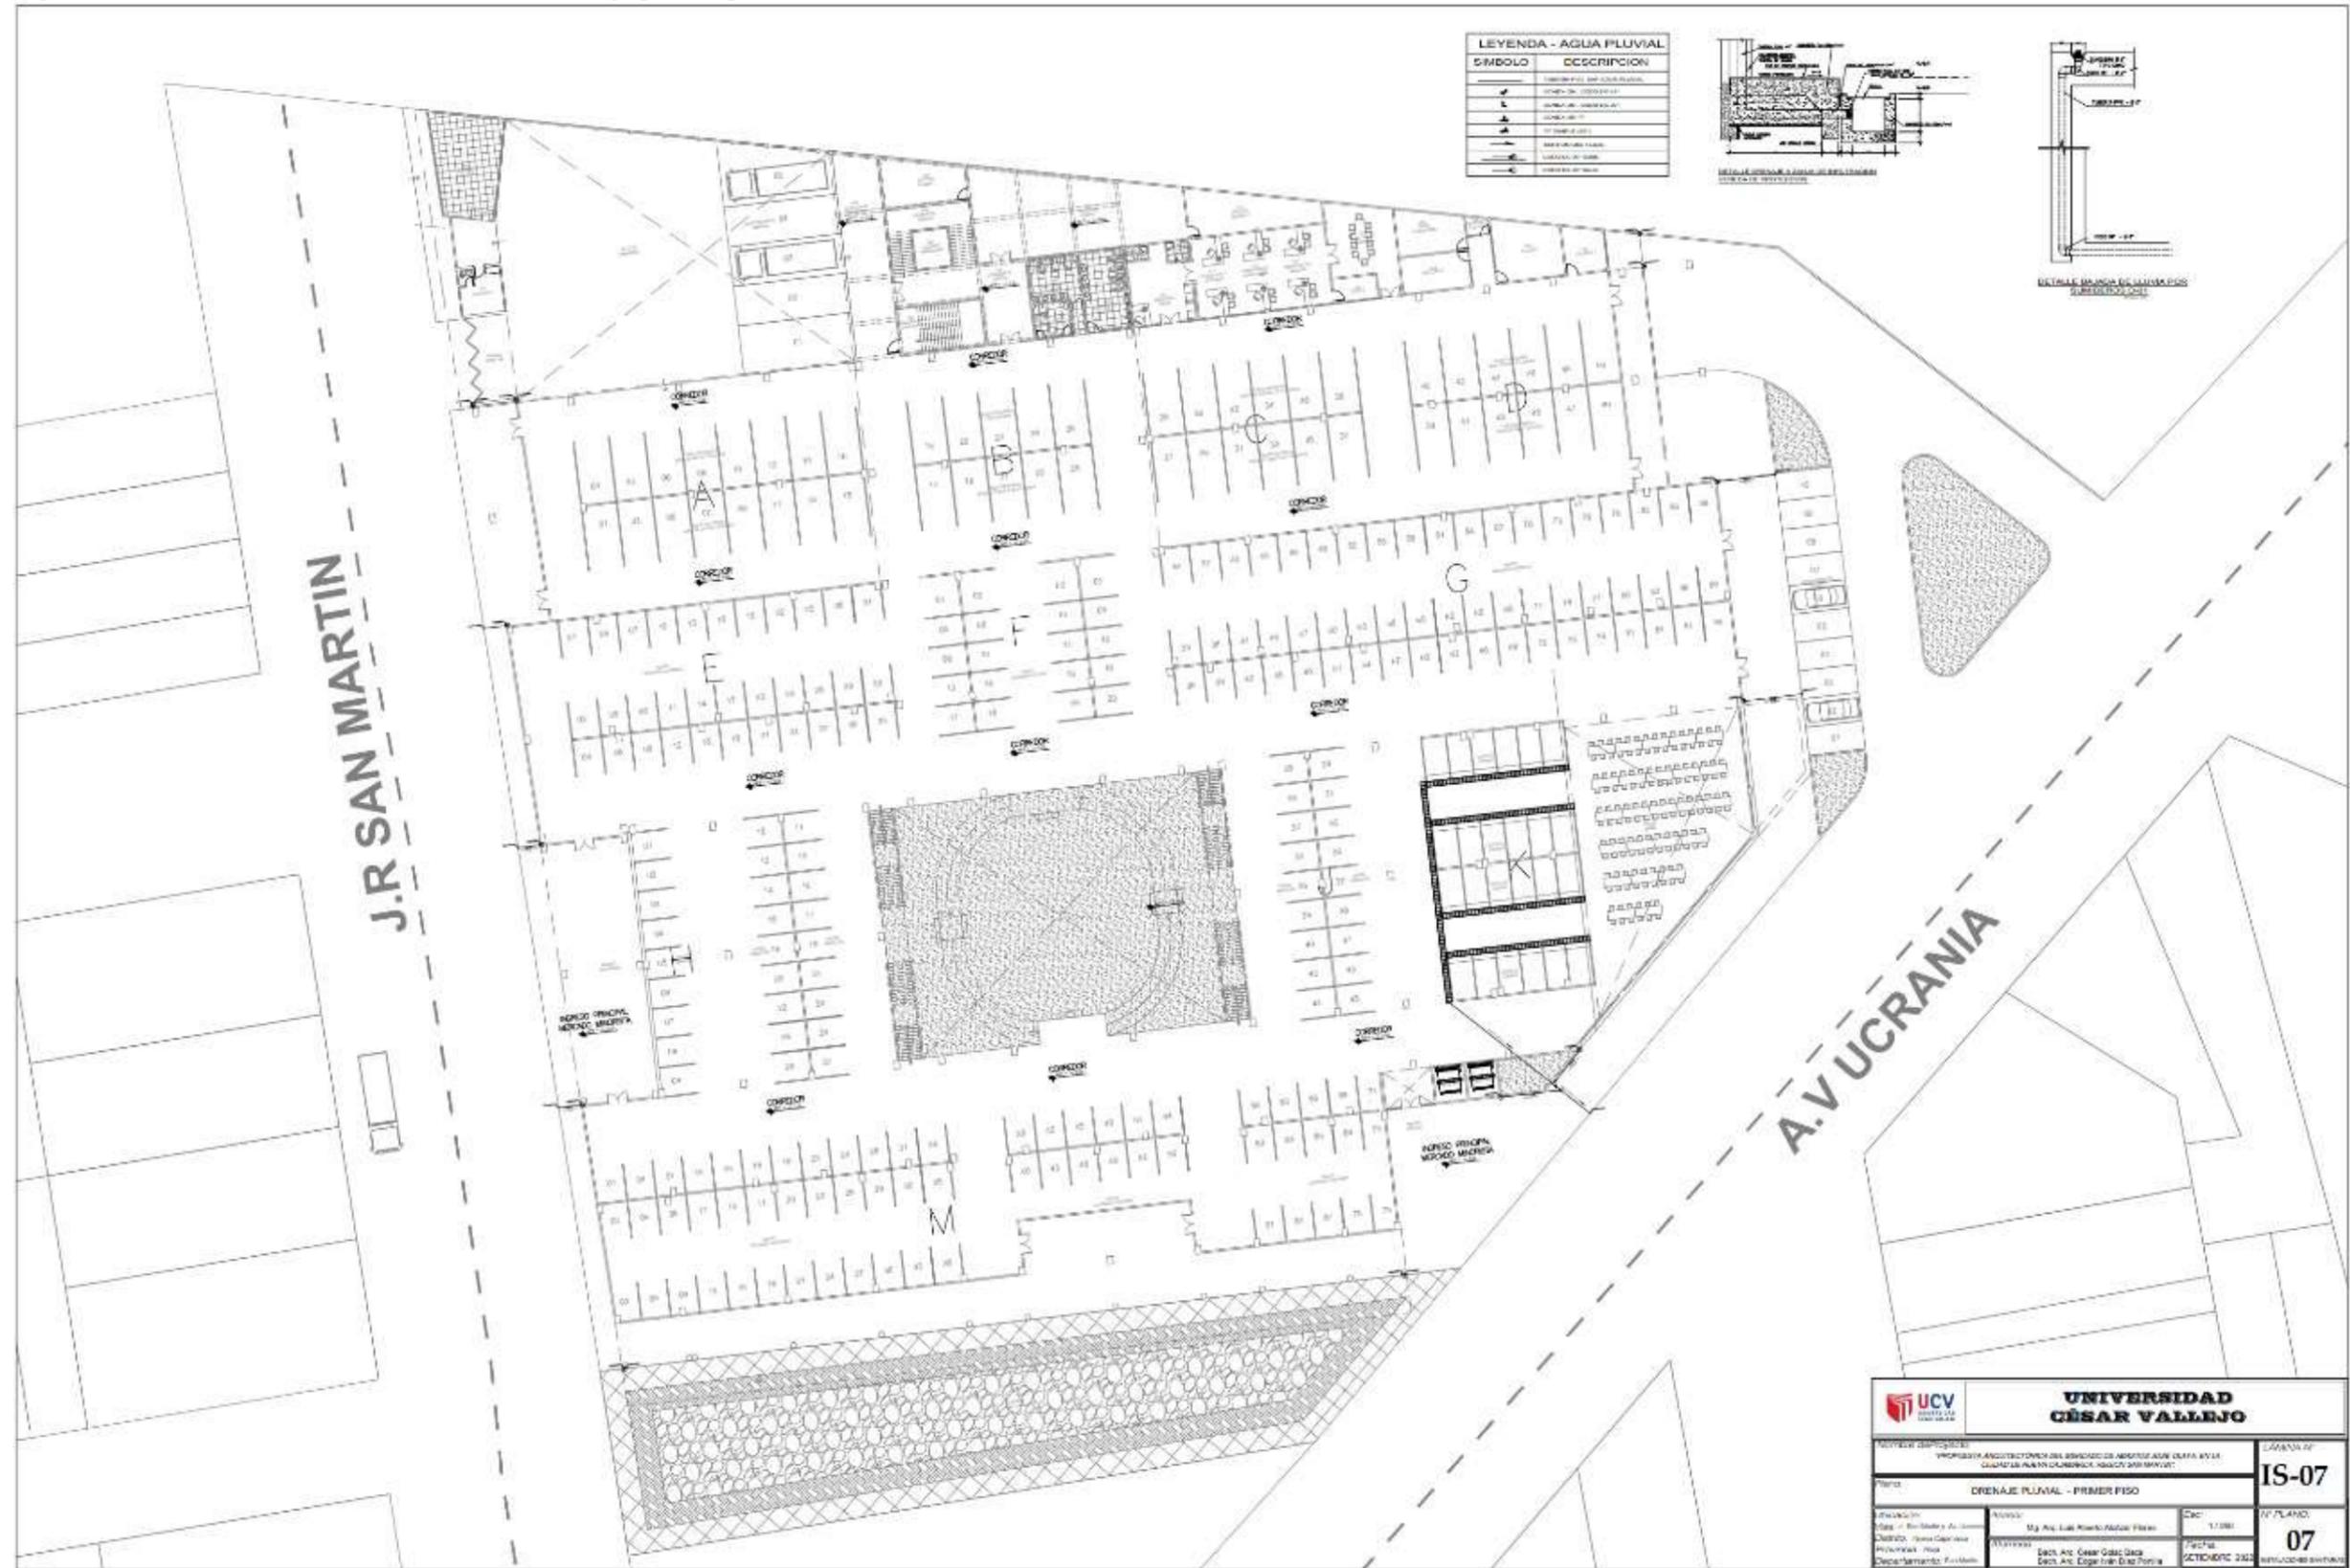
Planos de distribución de redes de drenaje pluvial segundo nivel
